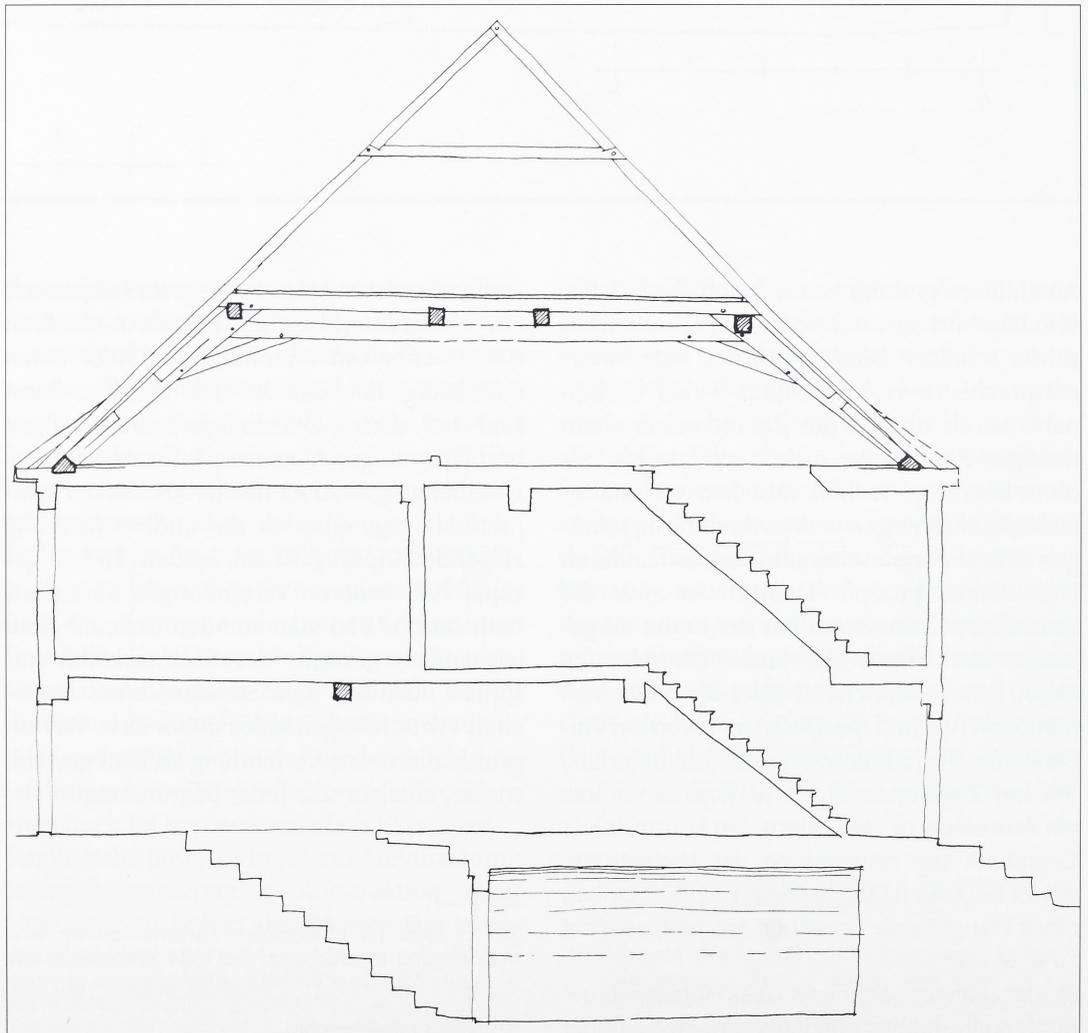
Vellberg, Haller Straße 10. Querschnitt. In dem 1723 entstandenen Dachwerk ist der obere Kehlbalken mit dem Gespärre verblattet. Maßstab 1:100.
